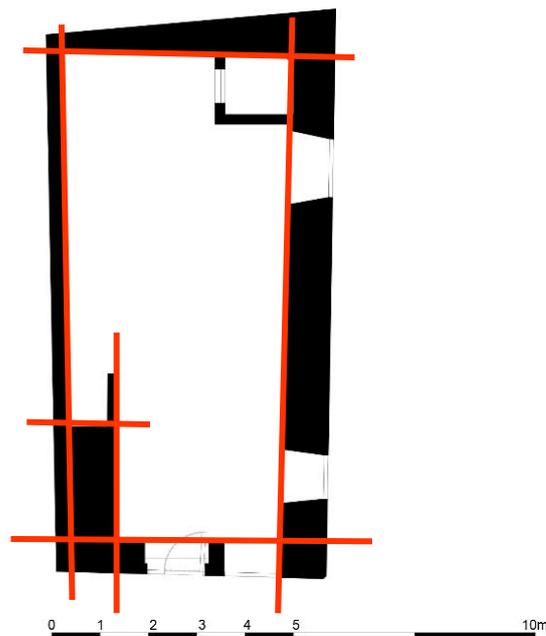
Planta baixa da loja 2 com marcação esquemática das paredes principais
